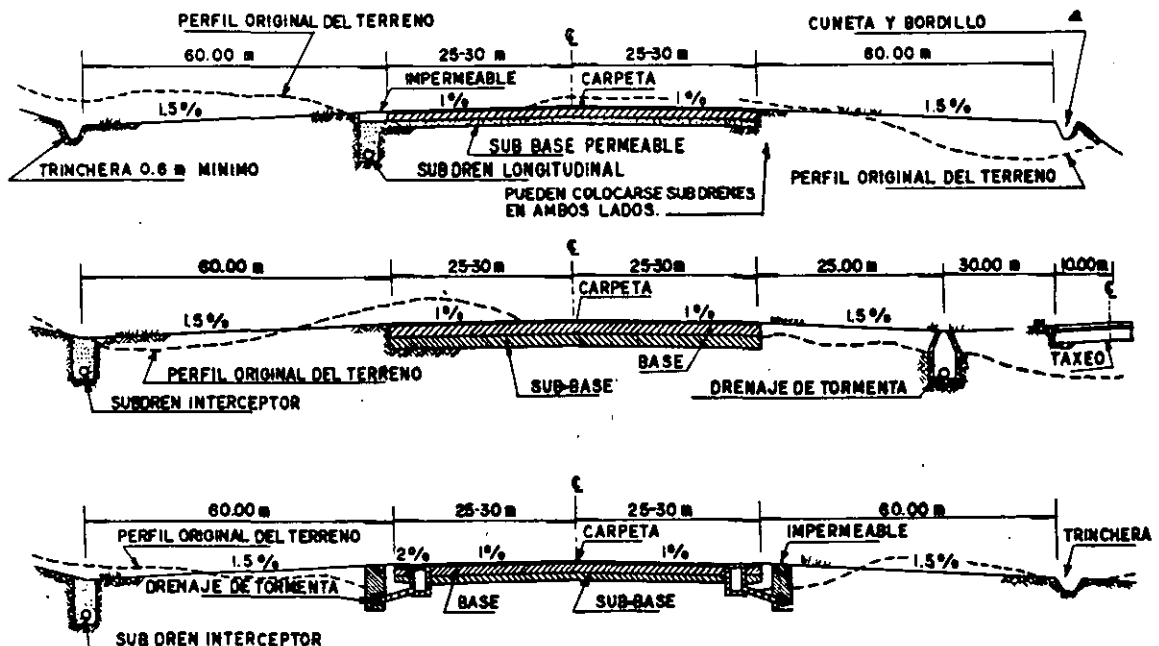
Instalaciones típicas de subdrenaje en aeropistas (Ref. 22).
